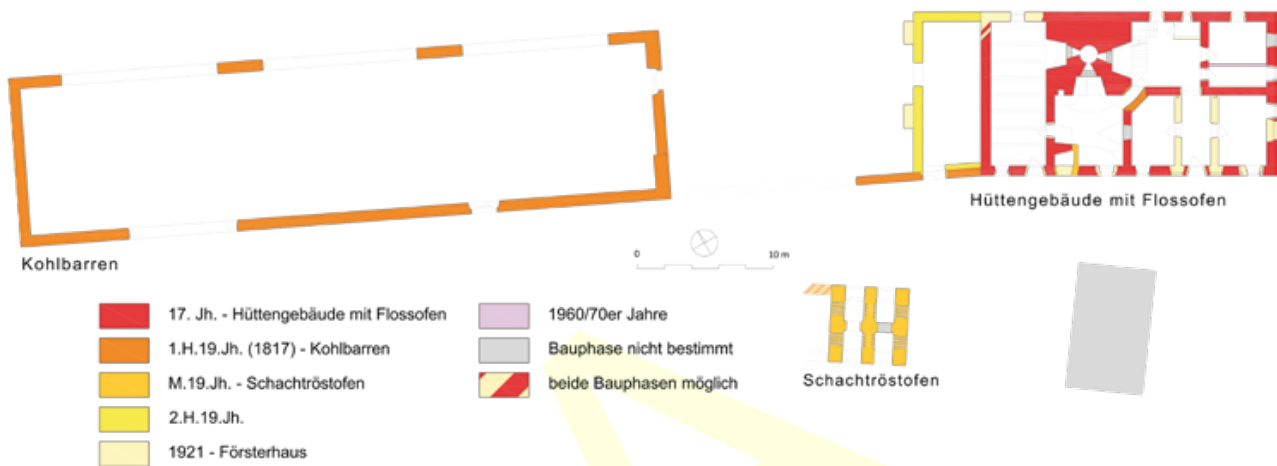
Kötschach, Blahaus. Baualterplan der Gesamtanlage.
